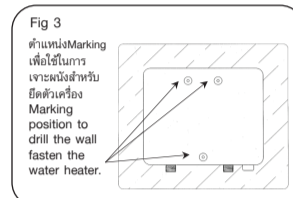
ตำแหน่งMarking เพื่งใช้ในการ เจาะผนังสำหรับ ยึดตัวเครื่อง Marking position to drill the wall for fasten the water heater.
